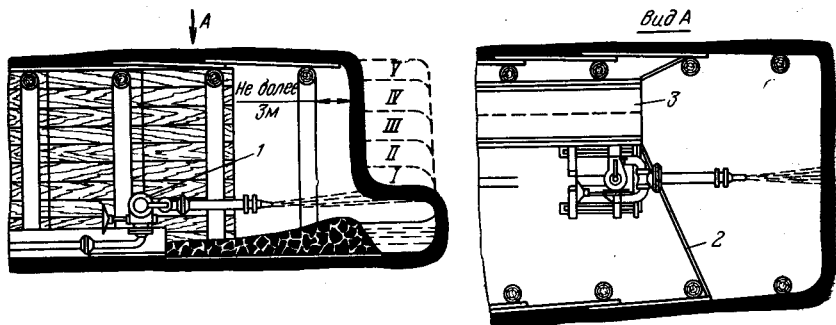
Схема проведения выработки при отбойке угля гидромонитором и самотечным гидротранспортированием по наклонным желобам:
